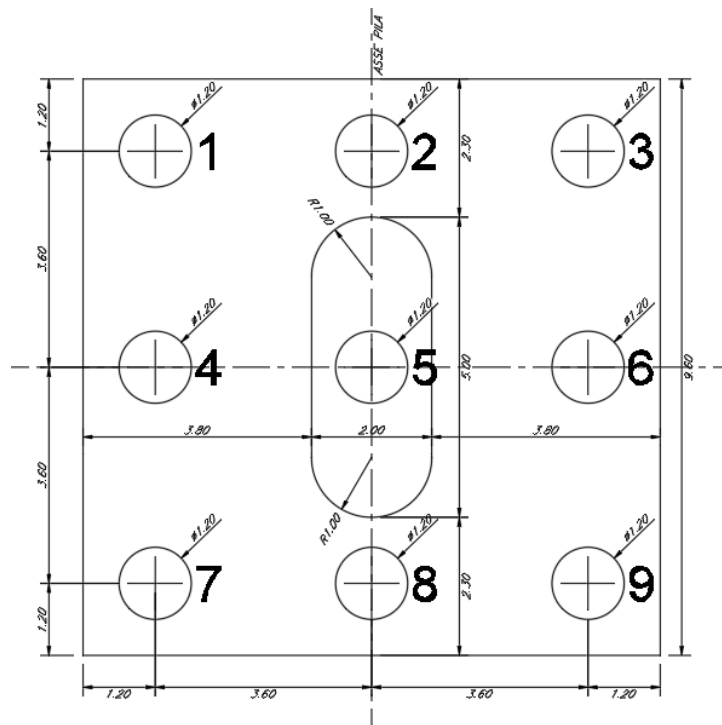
Vista in pianta zattera di fondazione con 9 pali di grande diametro
